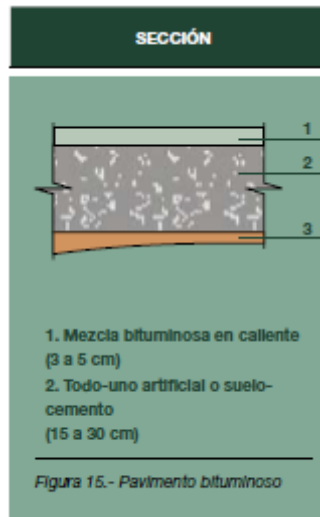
Perfil paquete estructural con pavimento bituminoso.
